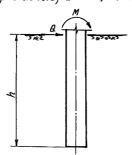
Безригельное закрепление опрокидываемого узкого фундамента глубокого заложения
